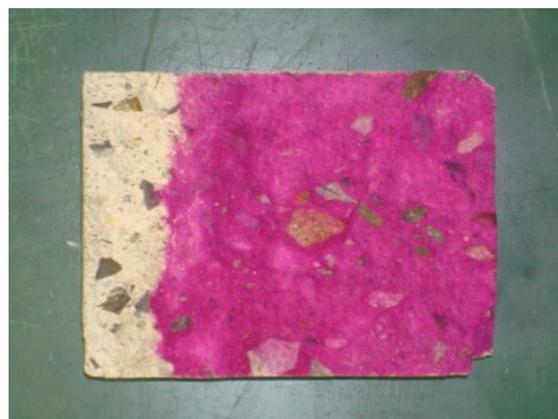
コンクリートコアの割裂面に試薬を噴霧した状況
